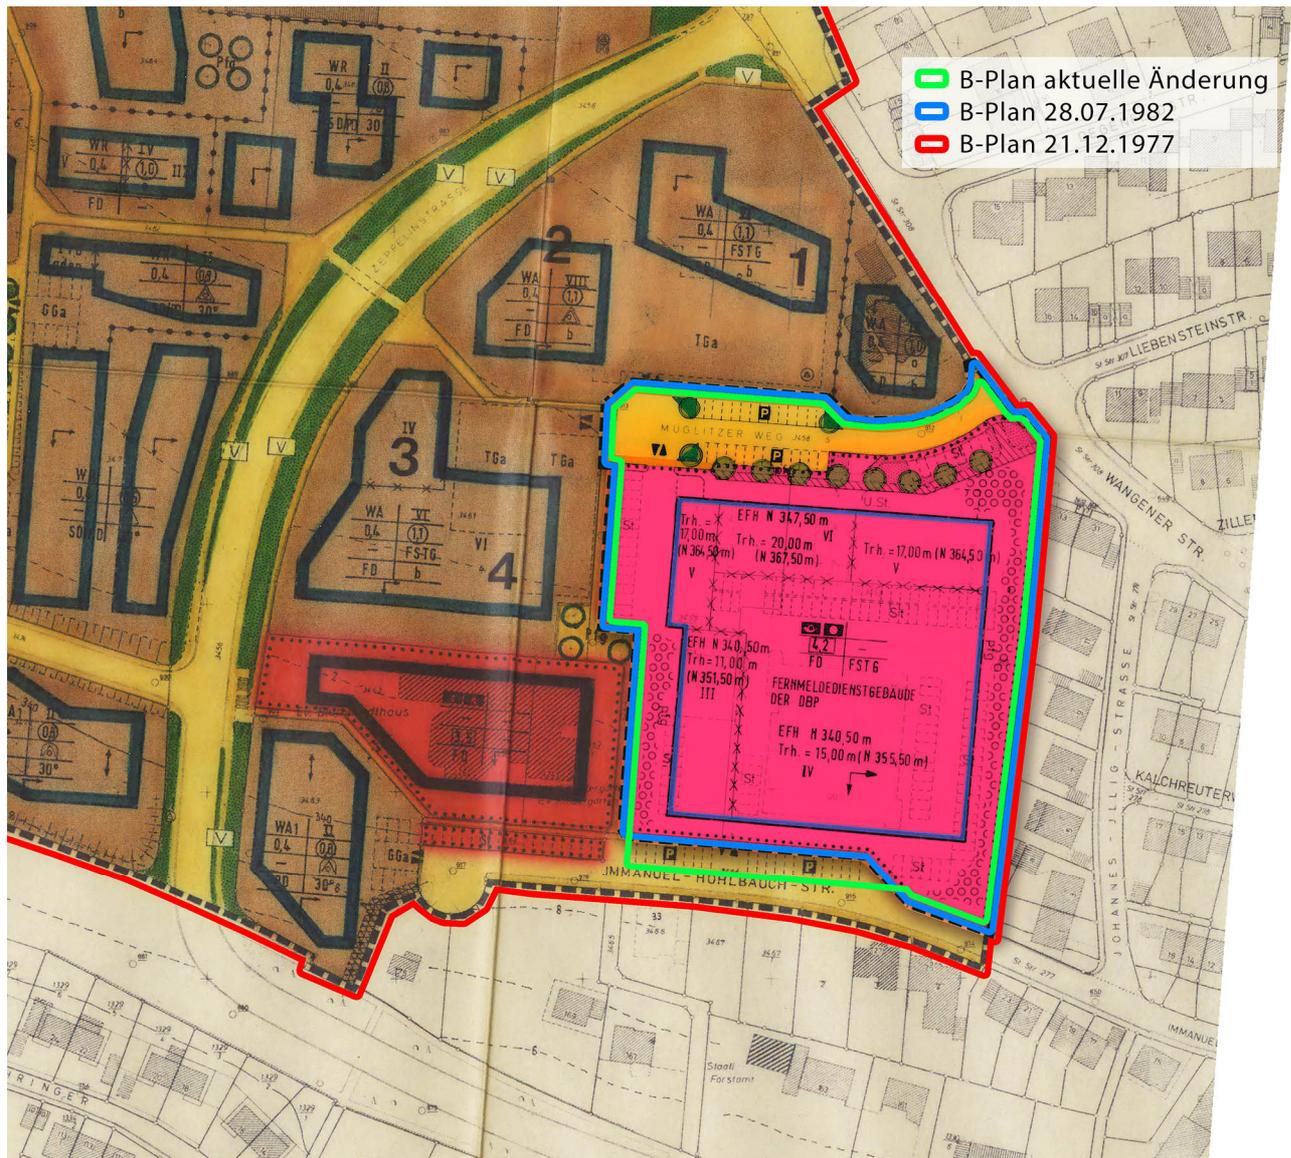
Überlagerung der maßgeblichen Bebauungspläne „REUSCH – OB DER HALDE, 1. Änderung und 2. Änderung“ mit Geltungsbereich der geplanten Änderung.
